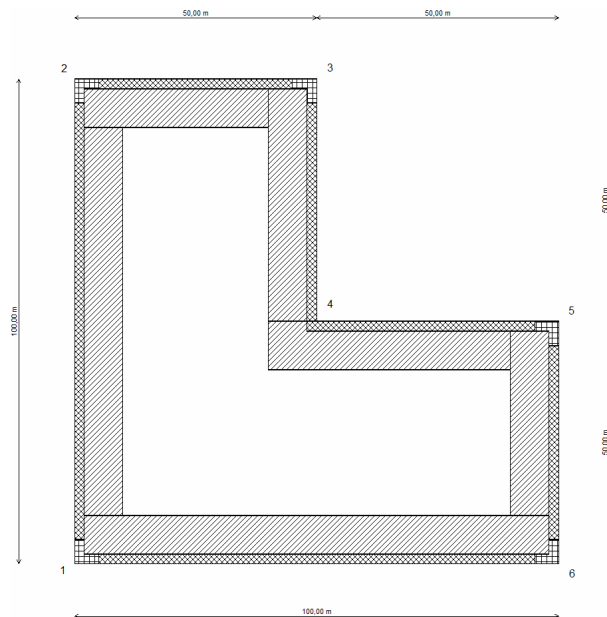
L-förmiger Grundriss (Quelle: MF Windsog Version 4)
